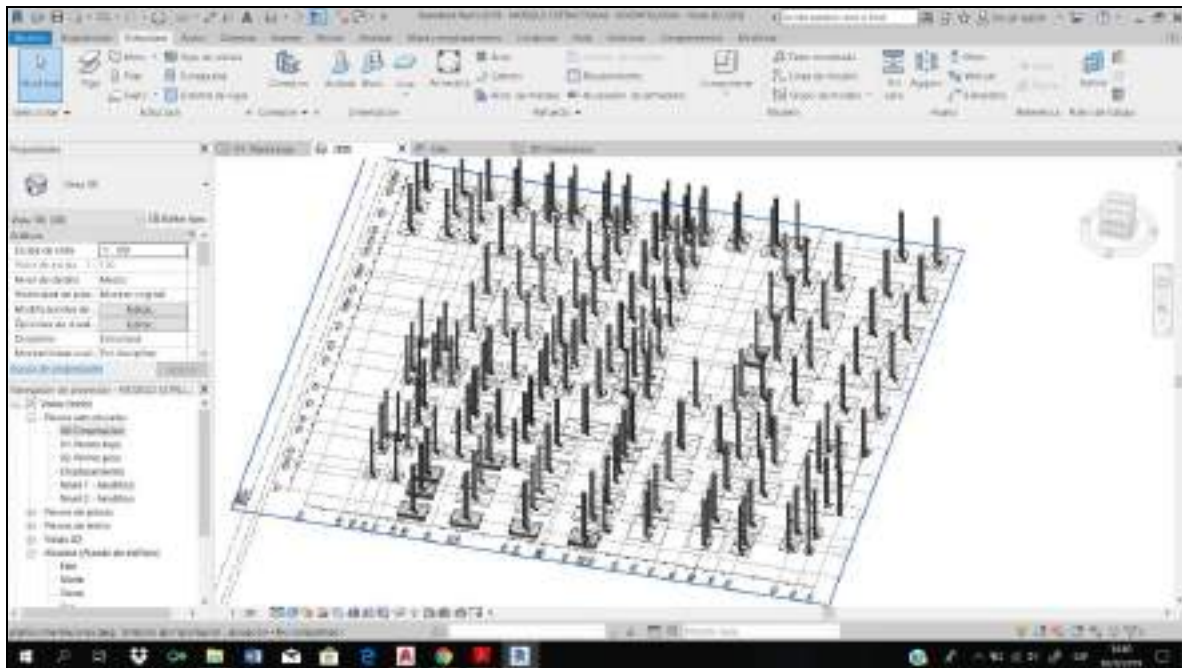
Revit- Vista 3D de alzado de pilares estructurales
